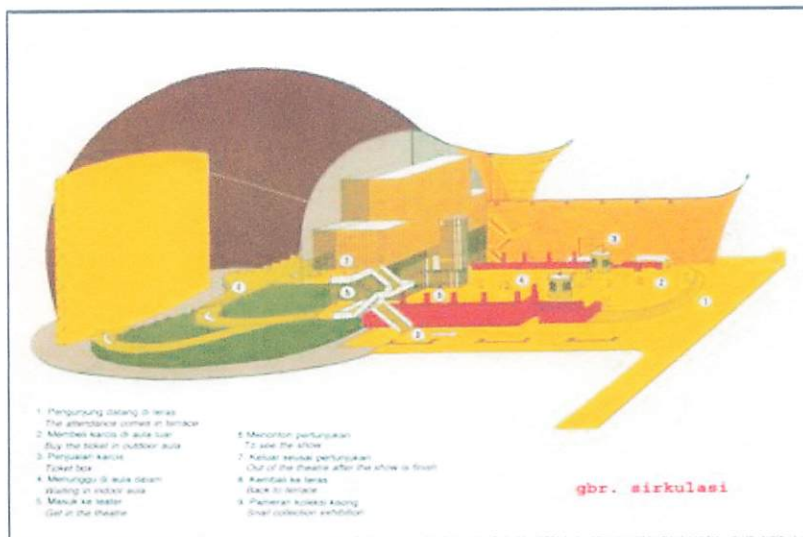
Denah Gedung Teater IMX Keong Emas
